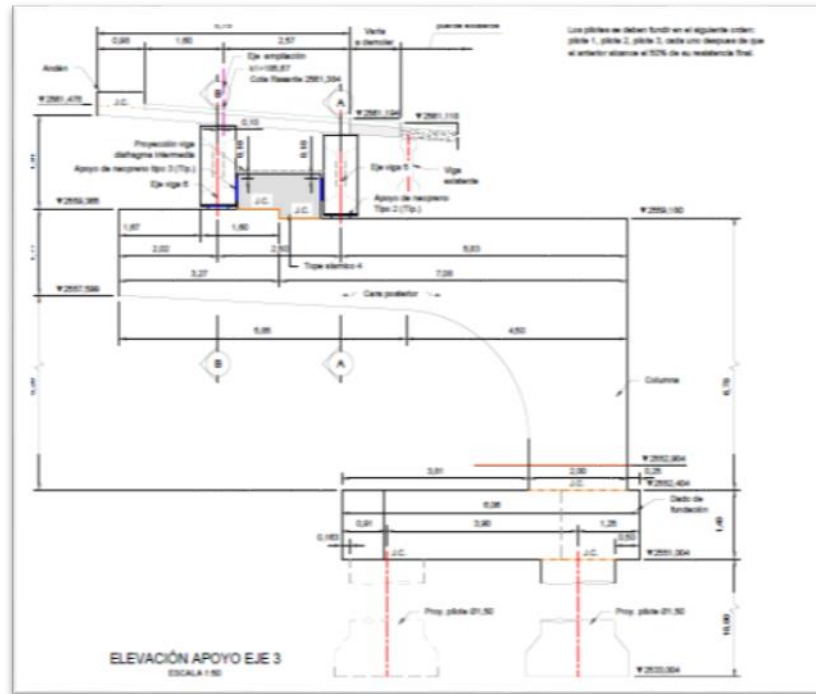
Detalle de Vigas Cabezal en Voladizo Puente de La Caro
